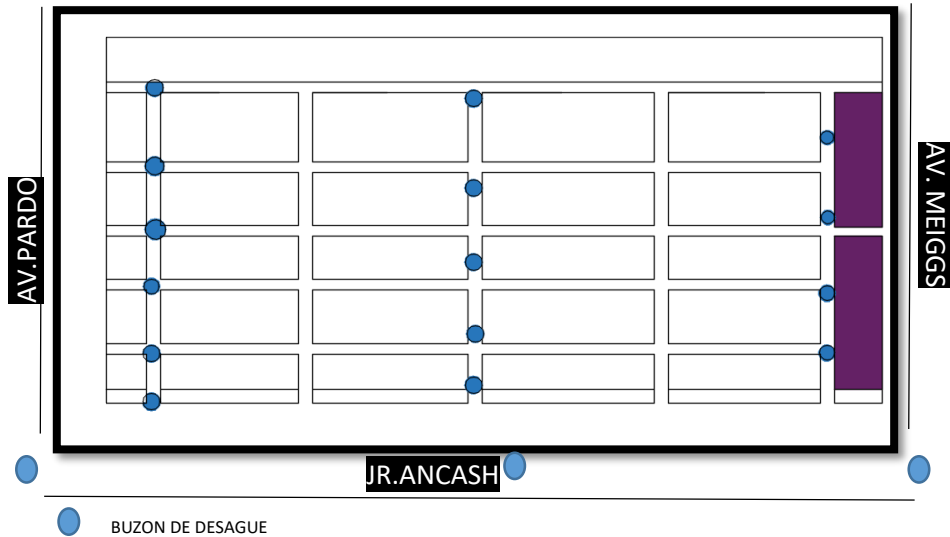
Plano de puntos de alcantarillado actual del mercado.
